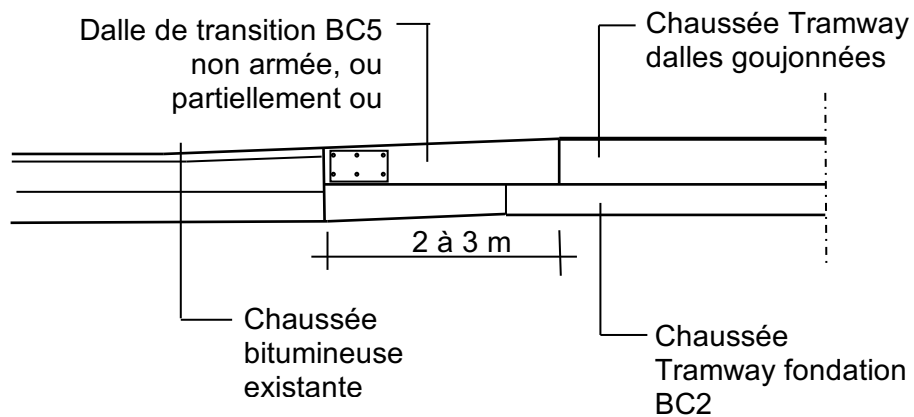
Raccordement de la voie Tramway avec les chaussées traversantes – coupe, schéma de principe
